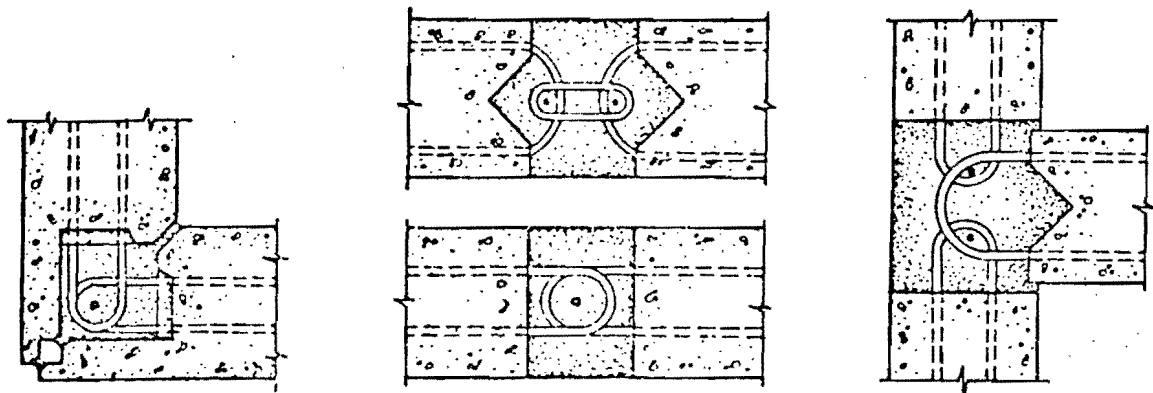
Detalles de conexiones verticales muro-muro con mortero (ref 8)
